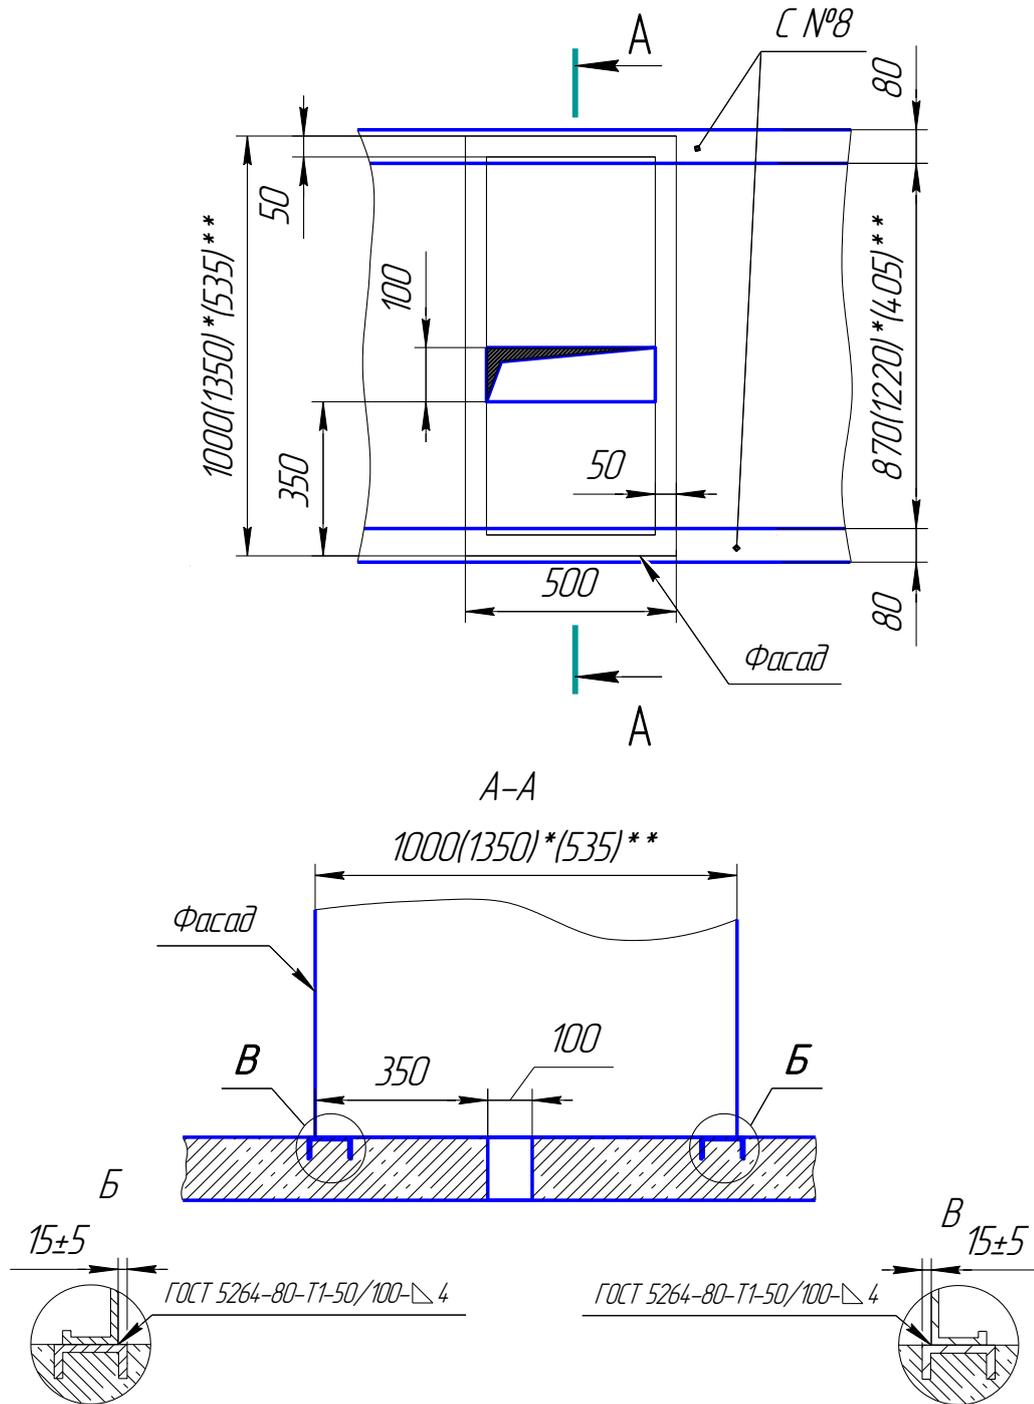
Установка шкафов РУНН на фундамент и ввод кабелей
